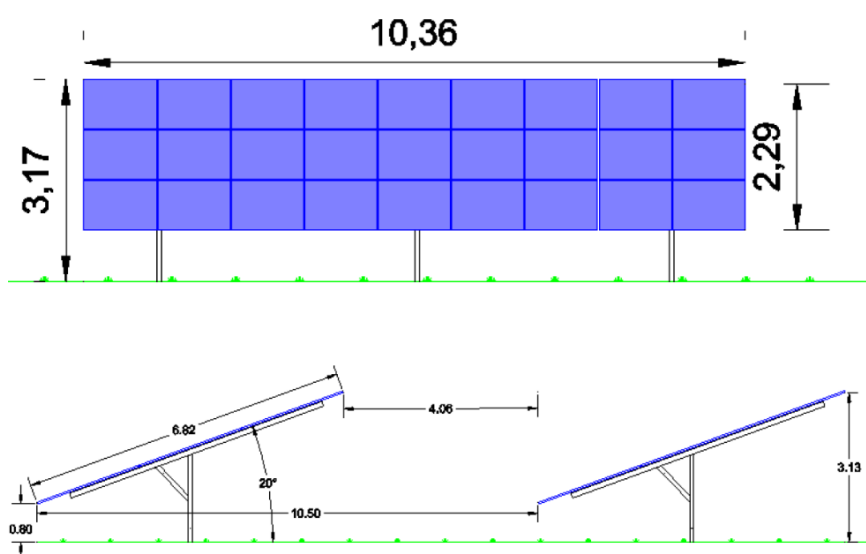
Vue de face et coupes des structures 3V9 inclinée à 20°
